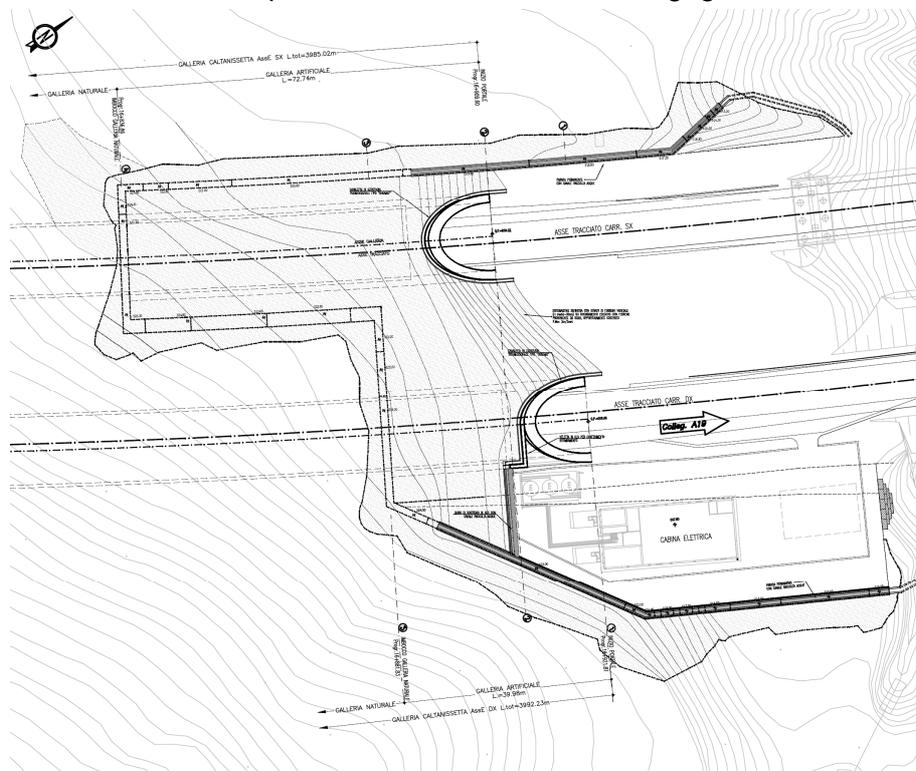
Galleria Caltanissetta – planimetria dell'imbocco lato A19 – sistemazione finale
